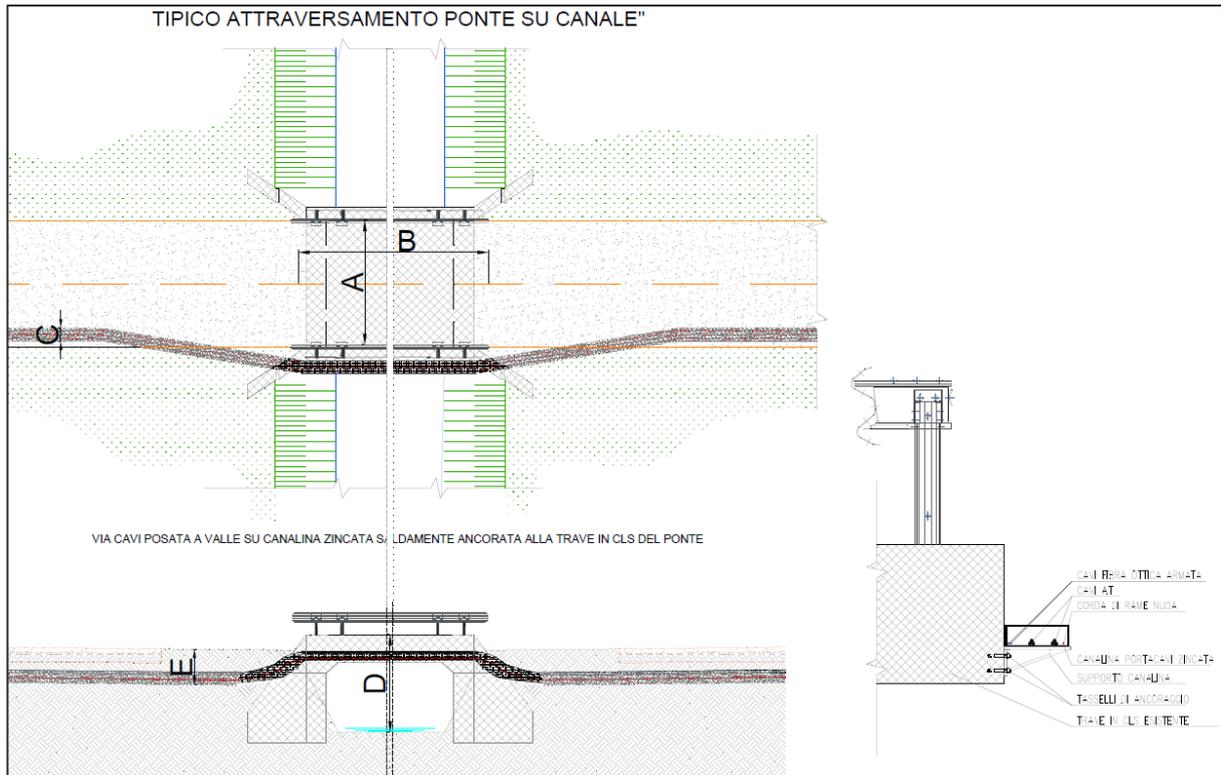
SEZIONE TIPO STAFFAGGIO CAVI SU PONTE
